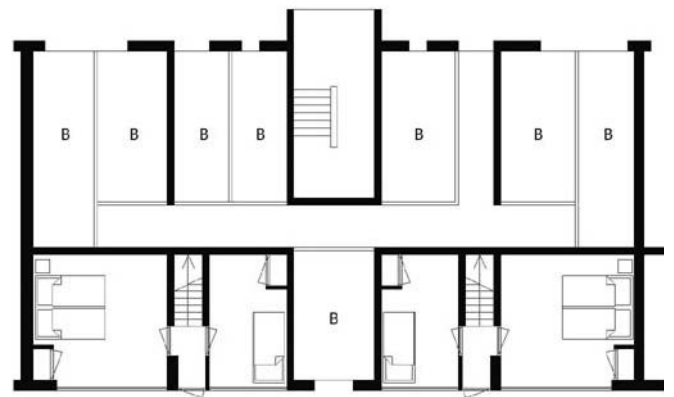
het voormalige trappenhuis wordt hal en kan ondanks de plaatsing van de nieuwe galerijontsluiting gebruikt blijven als men niet kiest voor renovatie.
